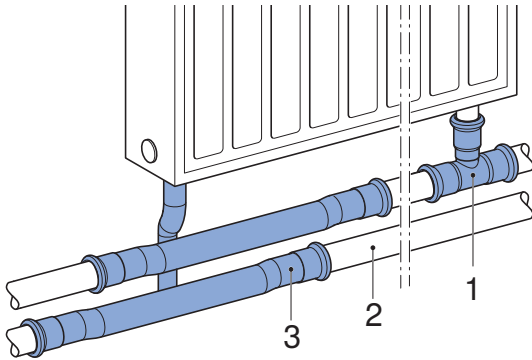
Conexiune la țeavă aparentă, cu distanță între tur și retur
